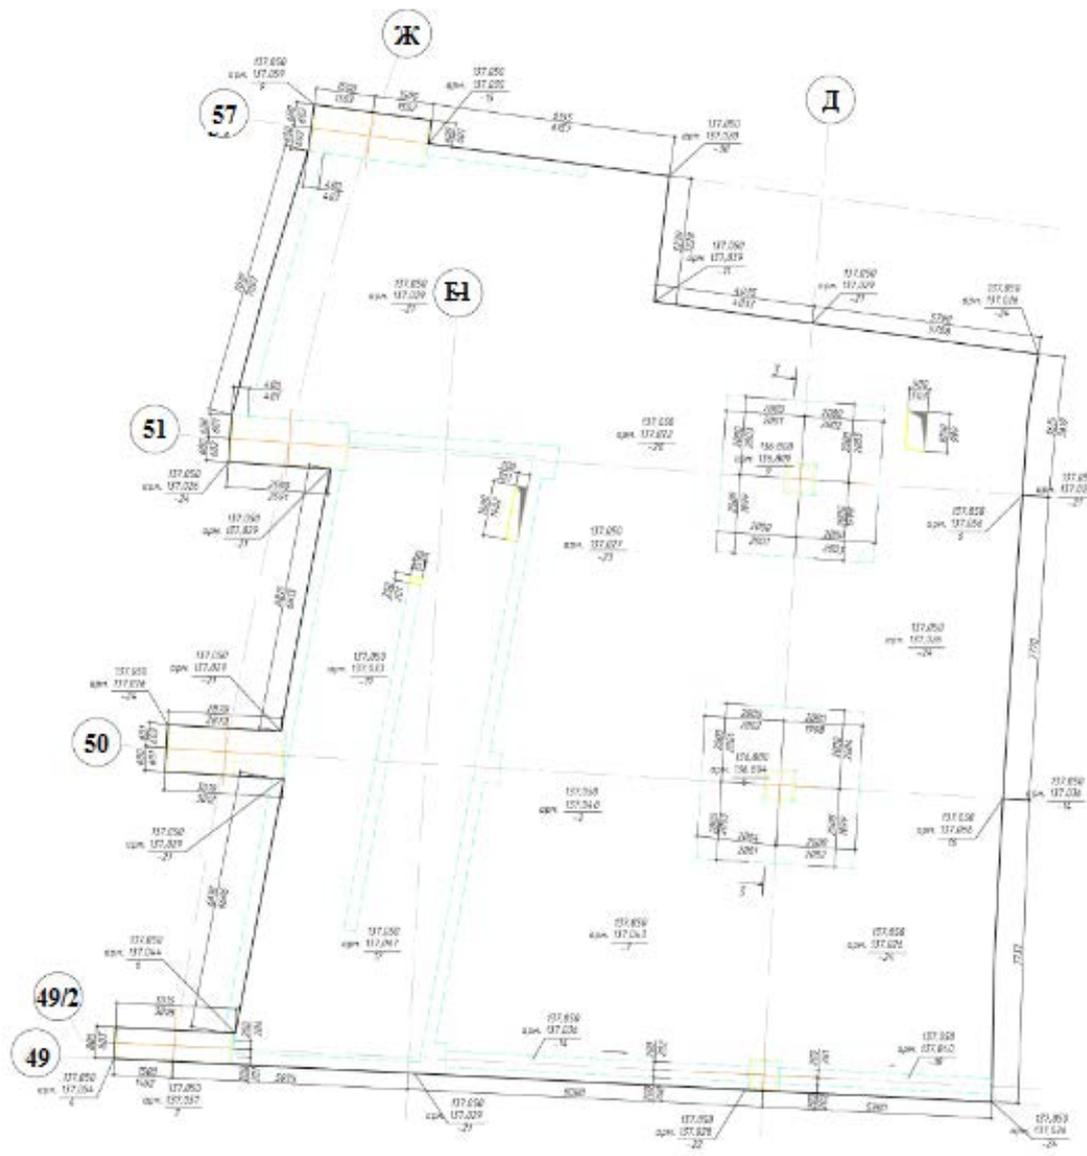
Фрагмент исполнительной съемки армирования плит перекрытия.
